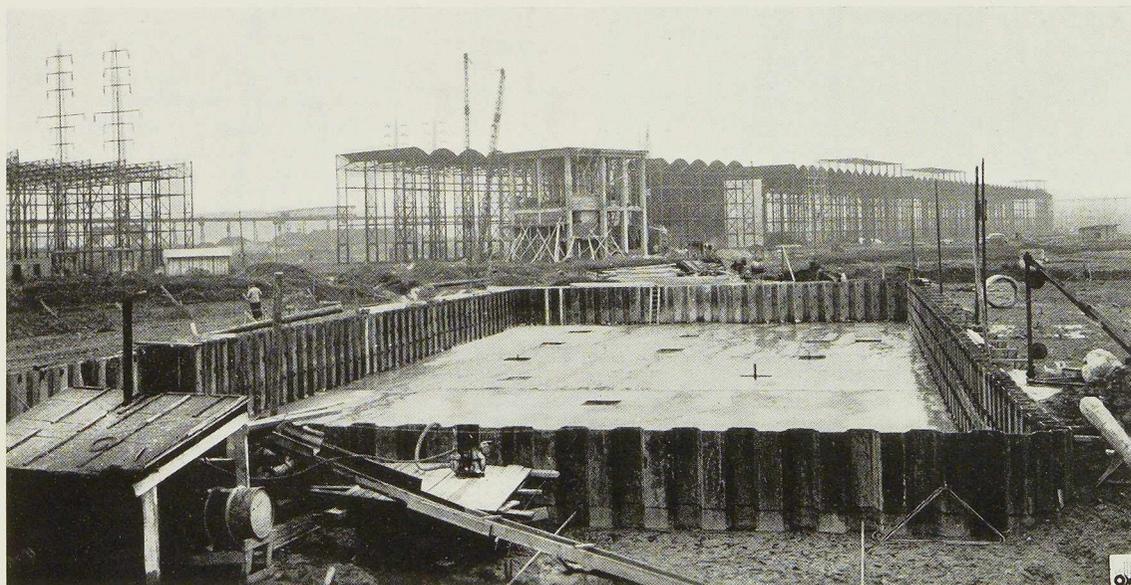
Vue de la piscine olympique de 50 × 20 mètres. La cuvette est constituée par des palplanches qui seront recouvertes de plaques de fibro-ciment.
